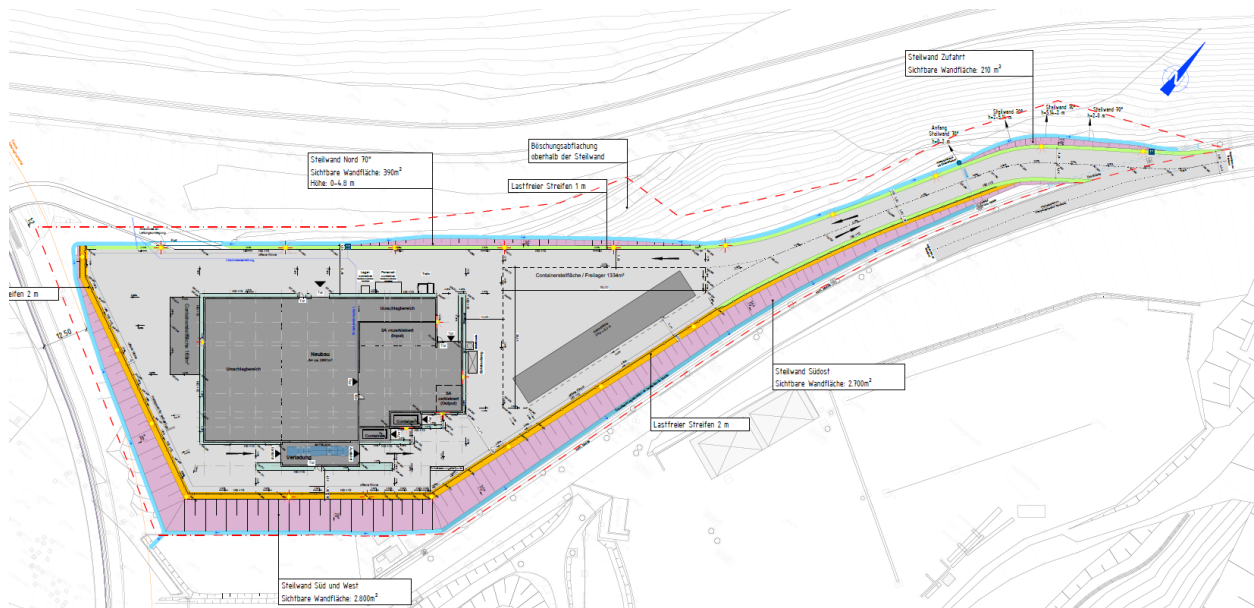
Ausschnitt Plan G 04 (Quelle SCHIRMER UT)
